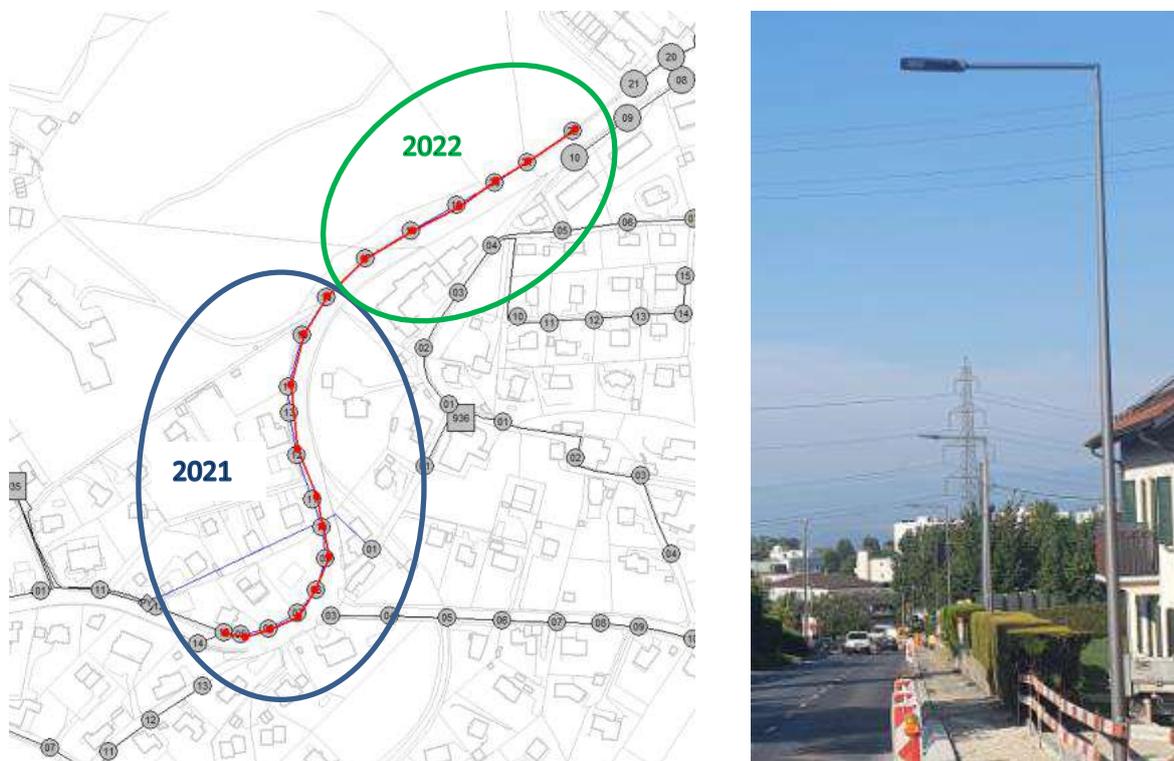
Plan de situation du secteur concerné par les travaux et photographie d'un point lumineux
